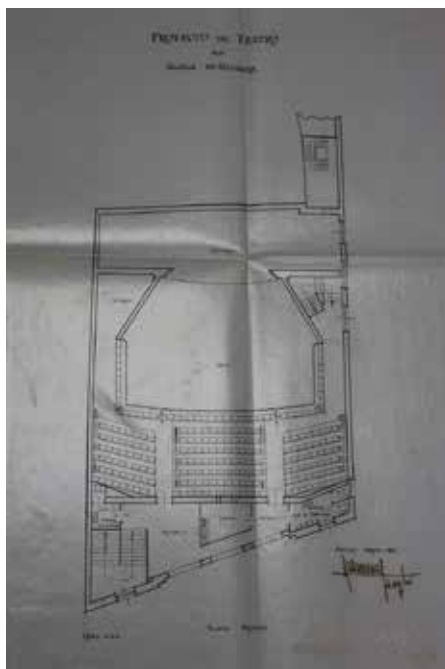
Teatro. Alcalá de Guadaira. Plano de la planta primera. J. Talavera Heredia. 1931 (AMAG).
